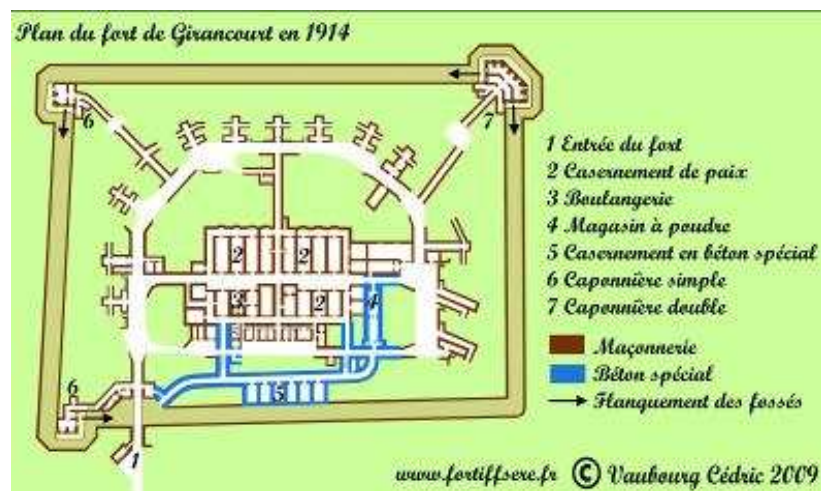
Plan du fort de Girancourt (Vaubourg 2009)
